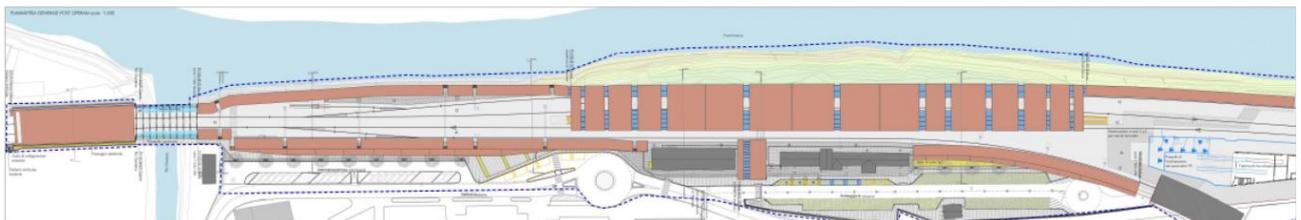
Interventi nella Stazione di Ponte Gardena: planimetria generale
